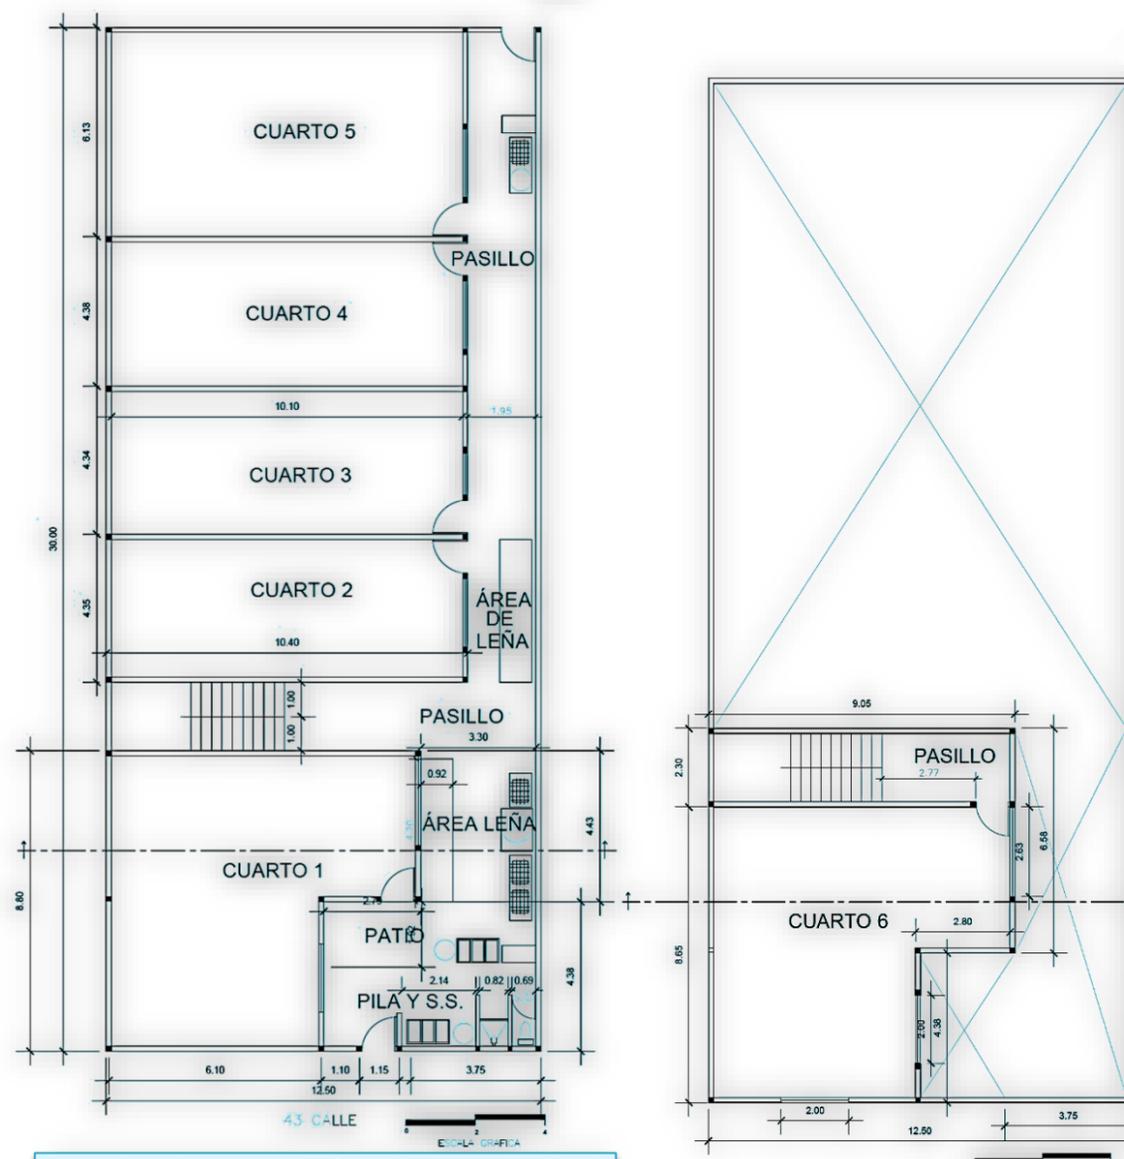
Planta arquitectónica piso 1 vivienda No. 2
